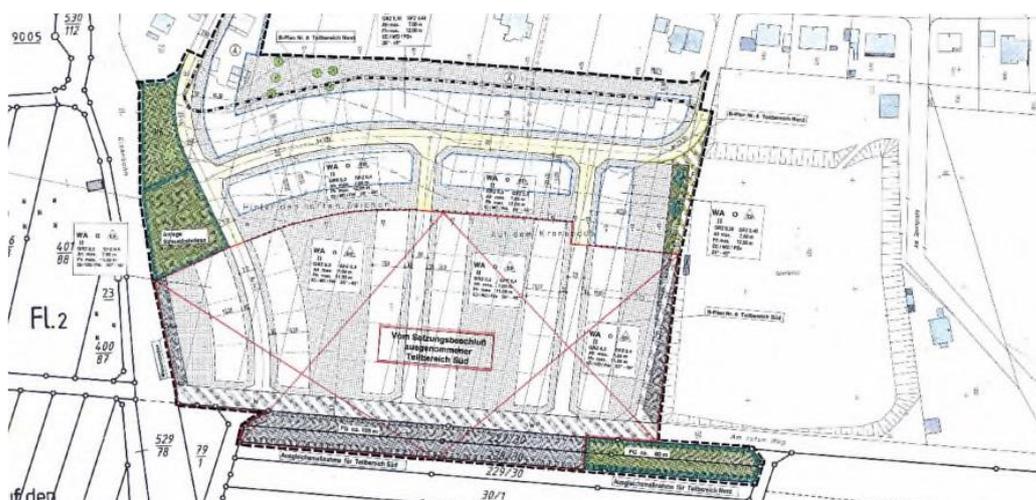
B-Plan Nr. 6 „Auf dem Kronsbach“ Darstellung der zurück genommenen Bauflächen
